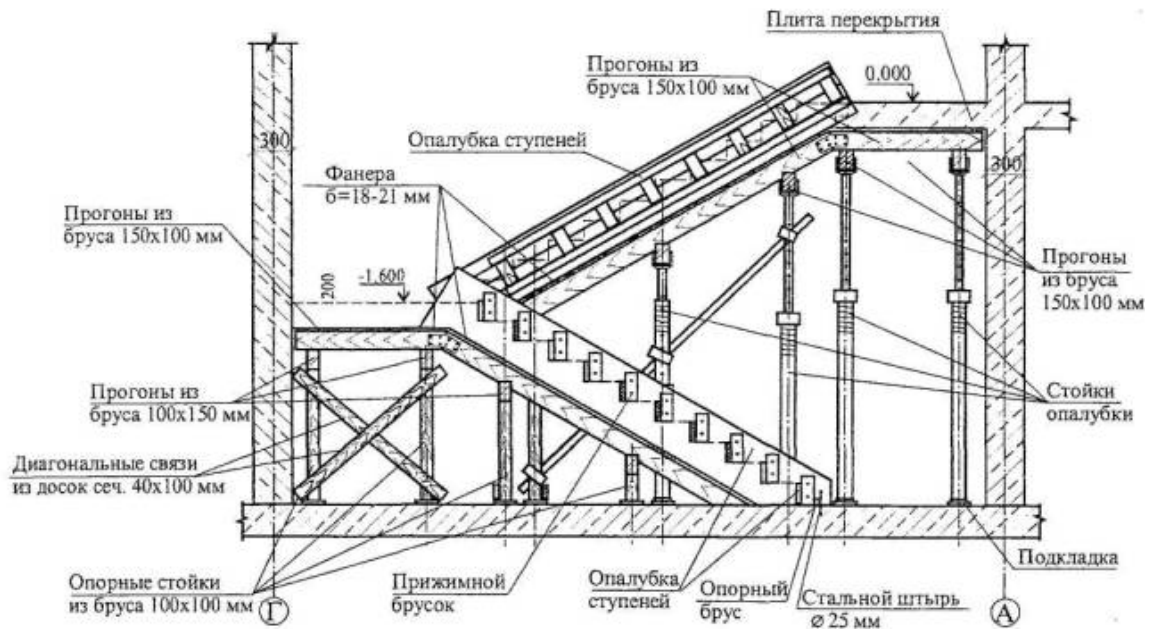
Вариант установки основных элементов опалубки лестничного марша
